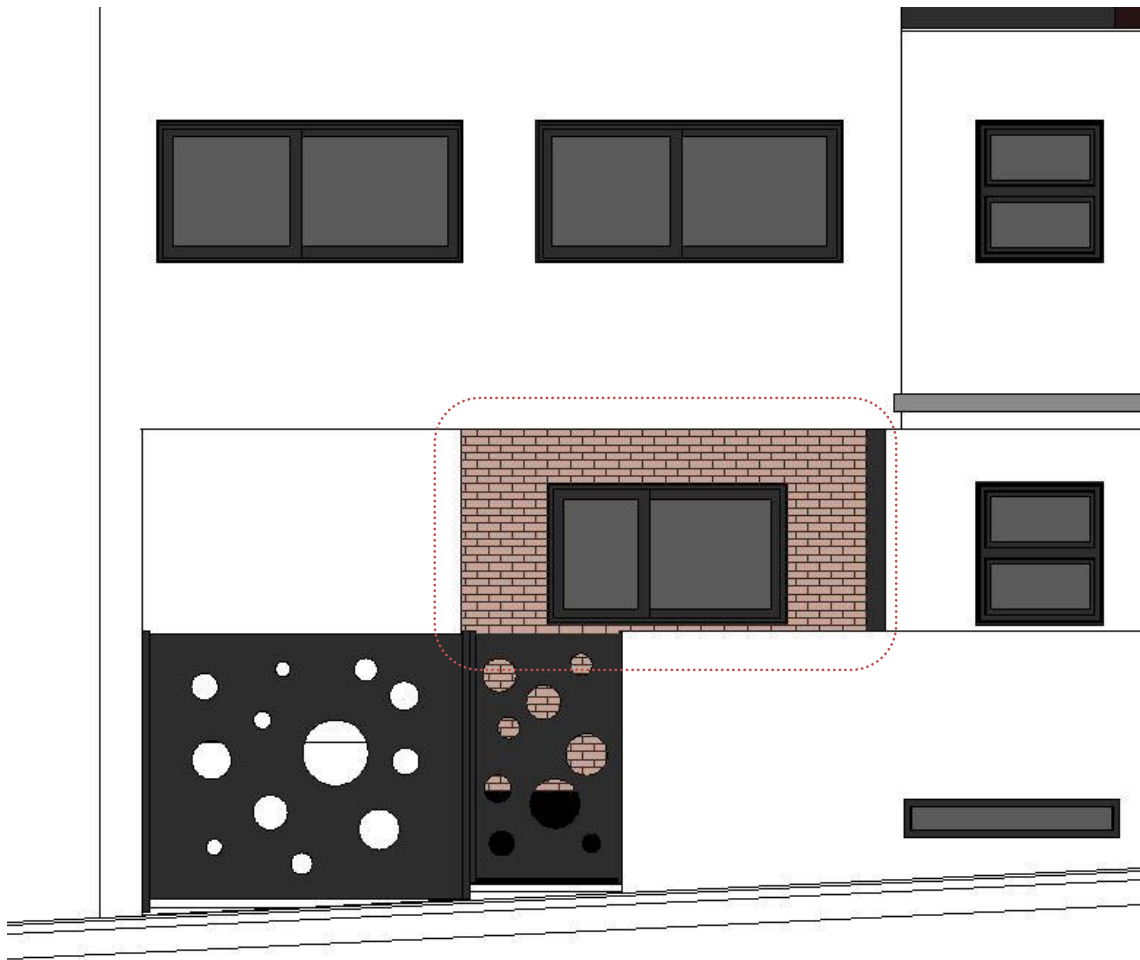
Revestimiento en alzado del Proyecto en AutoCad. Fuente: .dwg Hadit Arquitectos
